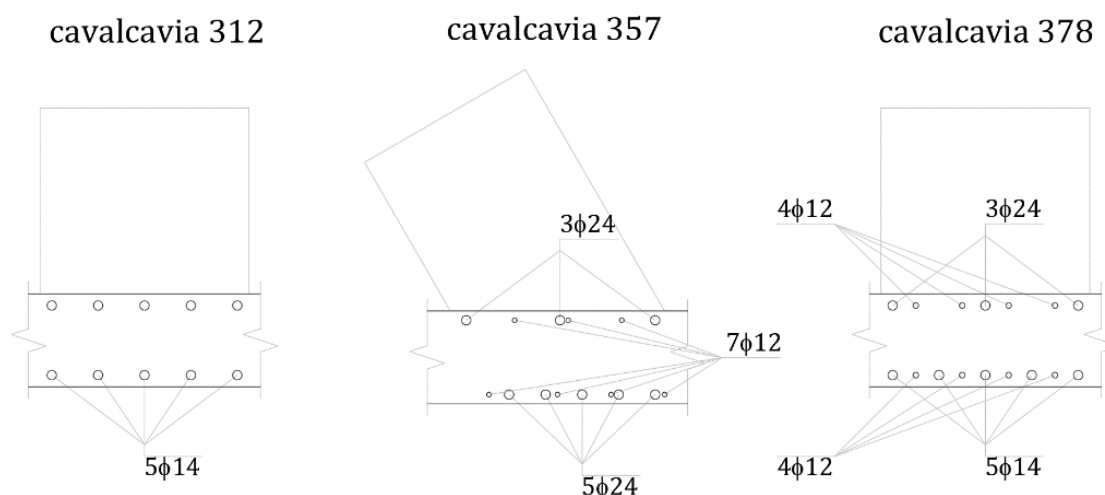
Sezione del traverso in corrispondenza del piedritto e disposizione dell'armatura (piano x-y)
